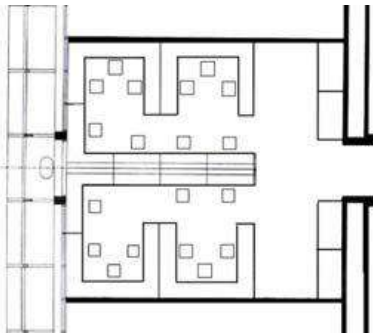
مسقط أفقي لقاعة تدريس لعدد ٢٤ طالب.
